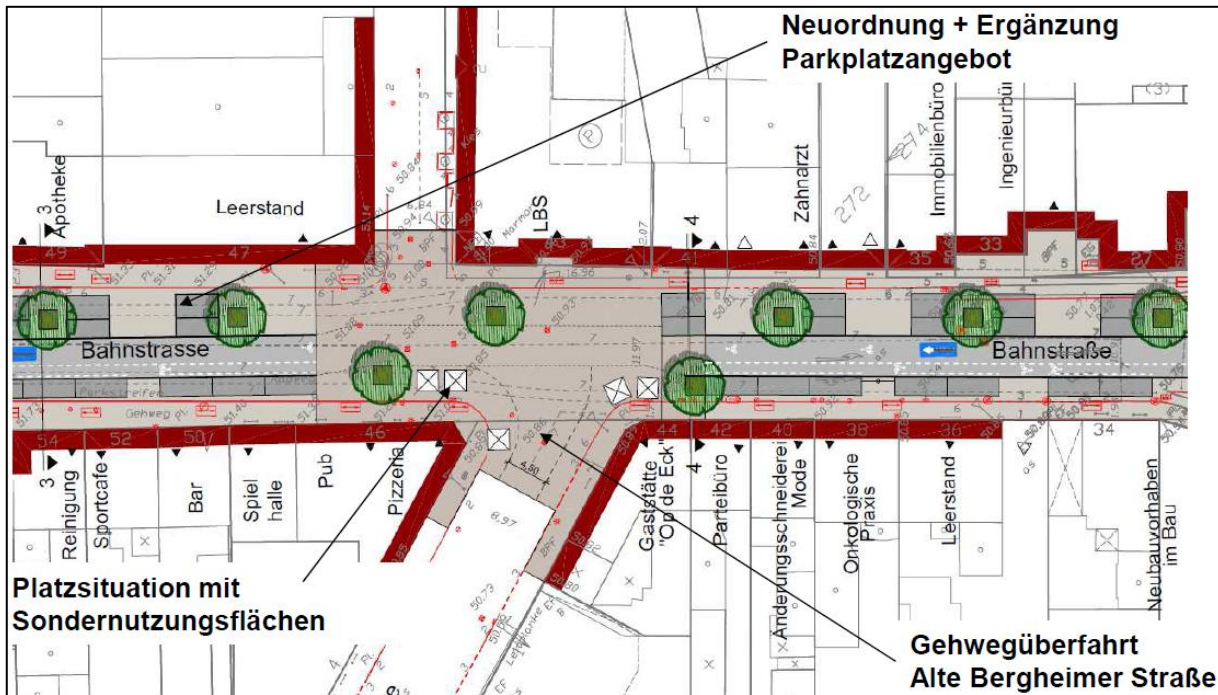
Detail Platz Bahnstraße / Alte Bergheimer Straße
